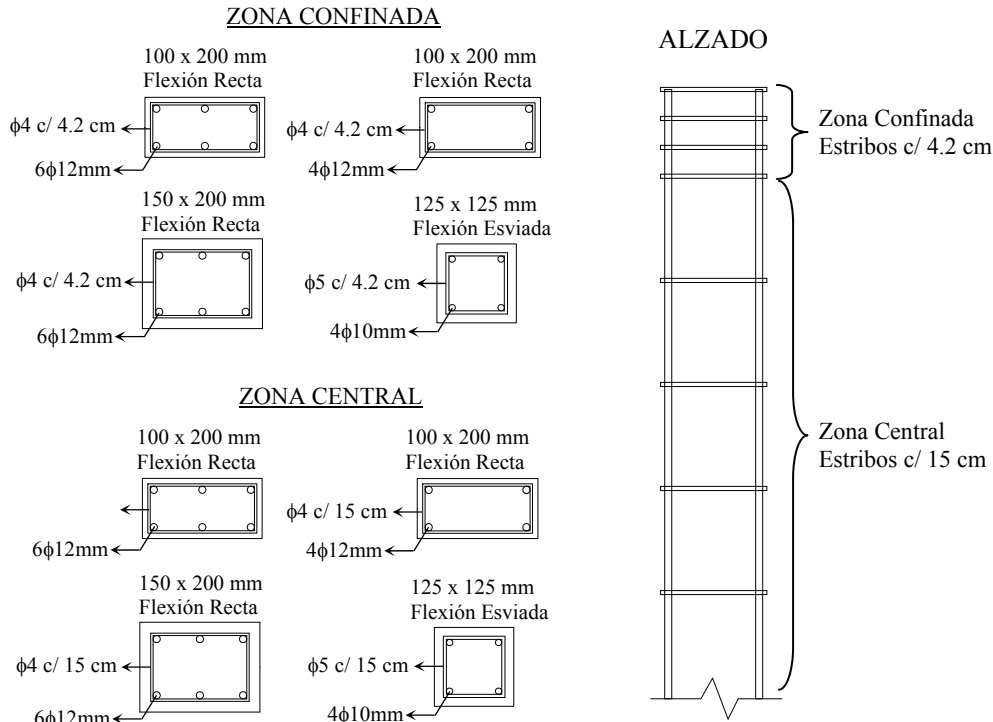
Croquis de la sección transversal de los soportes en la zona central y en la zona confinada y alzado de la ferralla.
